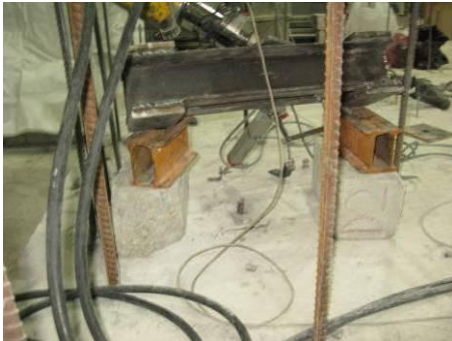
C25 Betona ekilen 12 mm S420a ankrajların deney sonu görüntüleri
